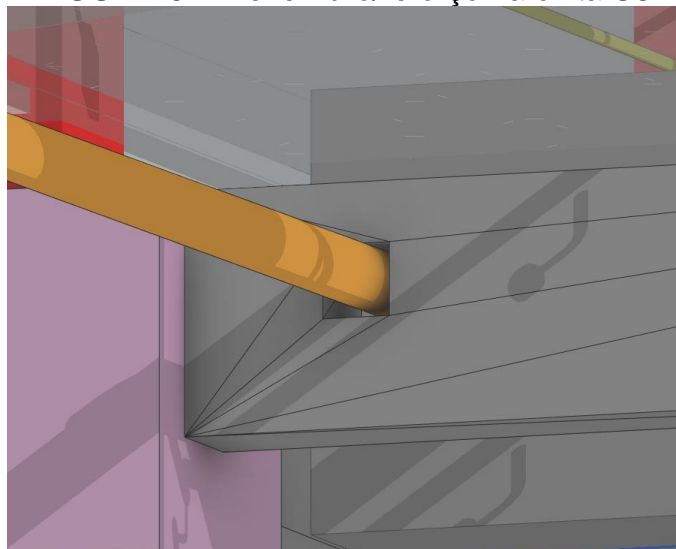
Resolução do pilar P5 com a janela do banheiro
